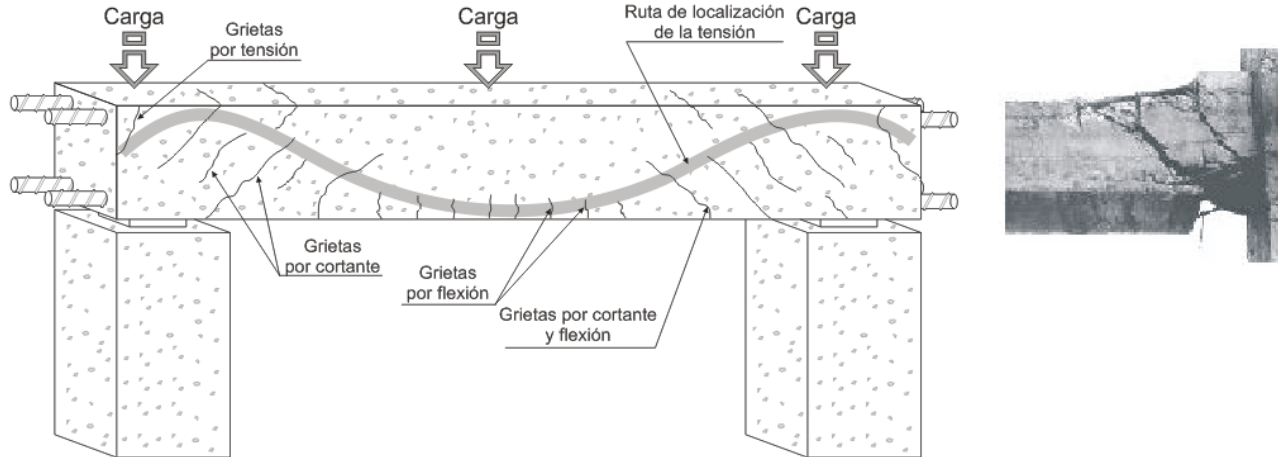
Grietas por cortante, flexión, tensión en vigas de concreto reforzado.
